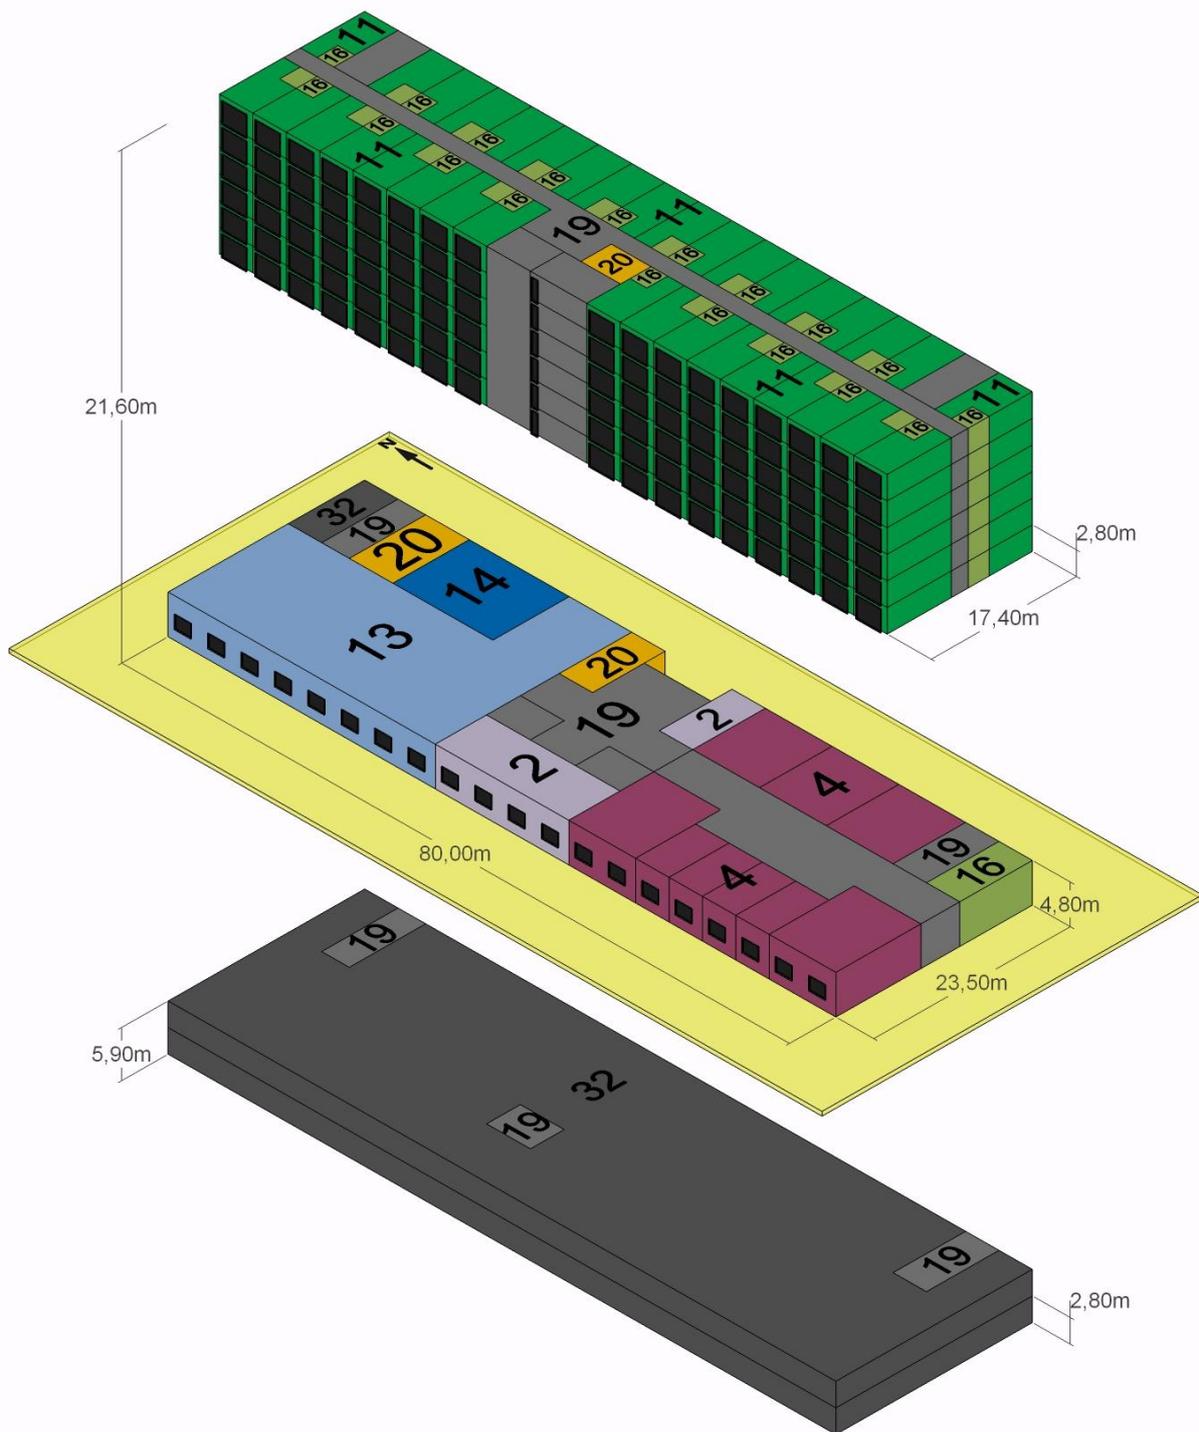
Hotels - groß - Darstellung Zonen - Ansicht Süd-West
